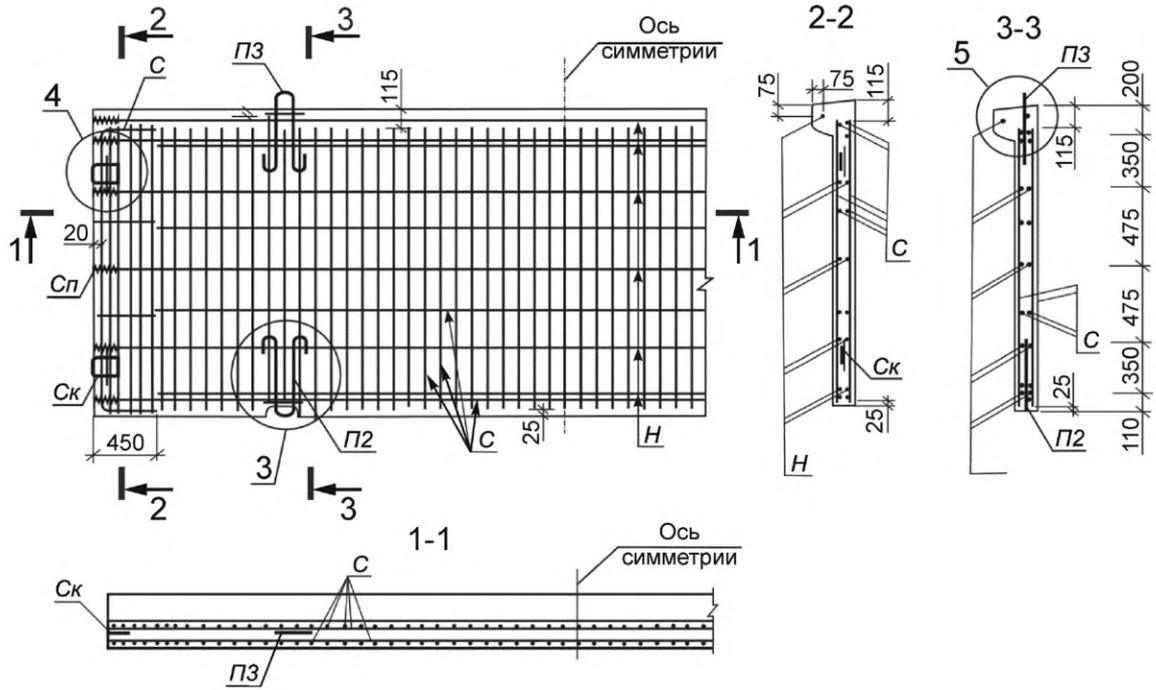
Схема армирования плиты ПБ60.18
